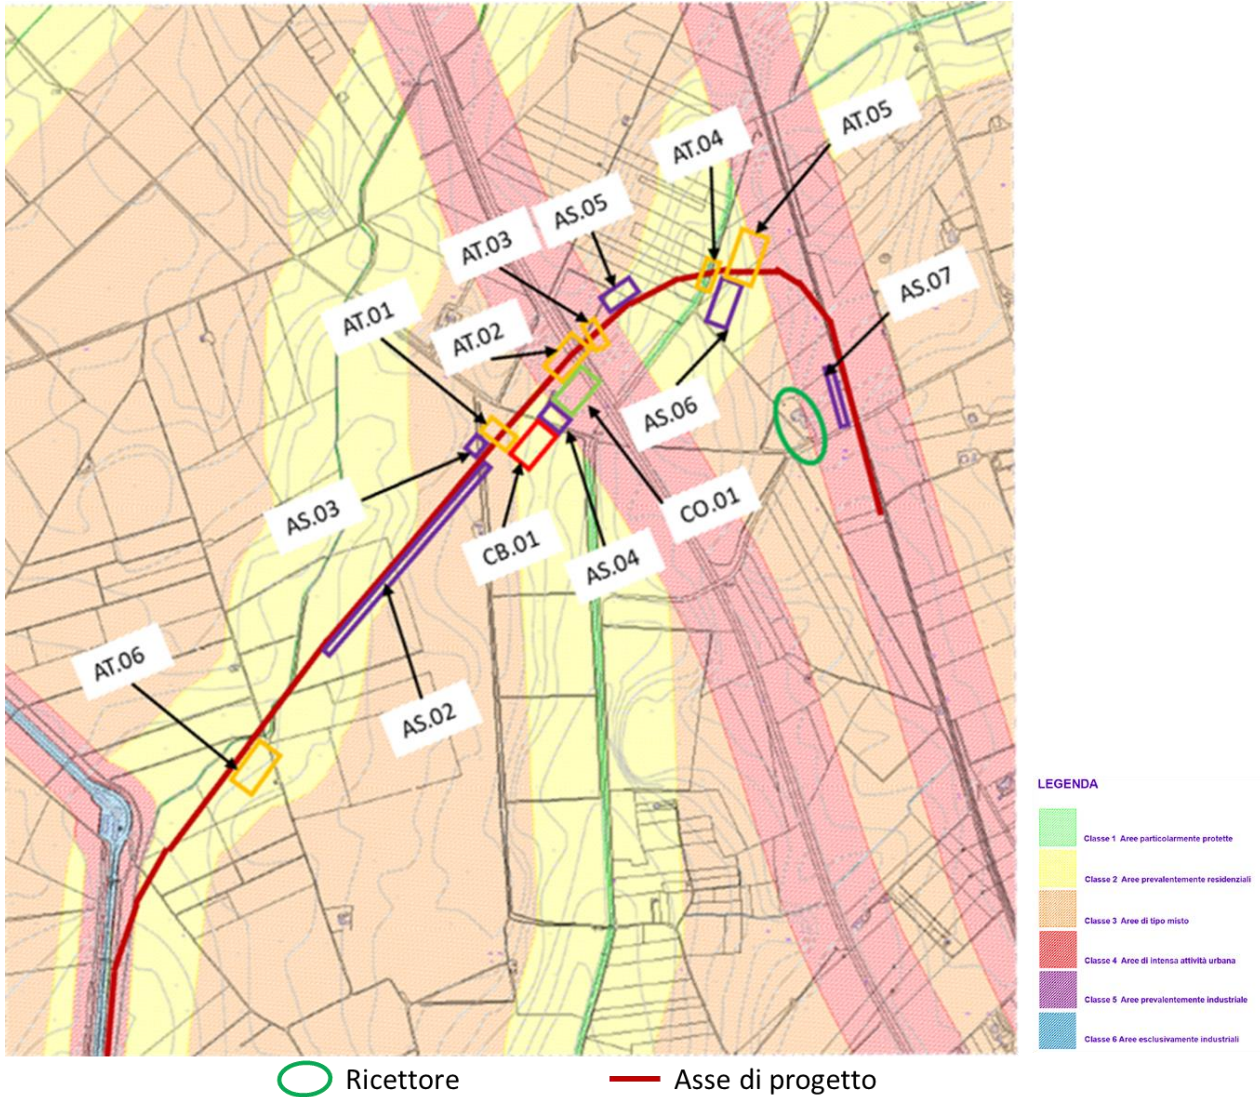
Localizzazione aree di cantiere rispetto alla zonizzazione acustica
